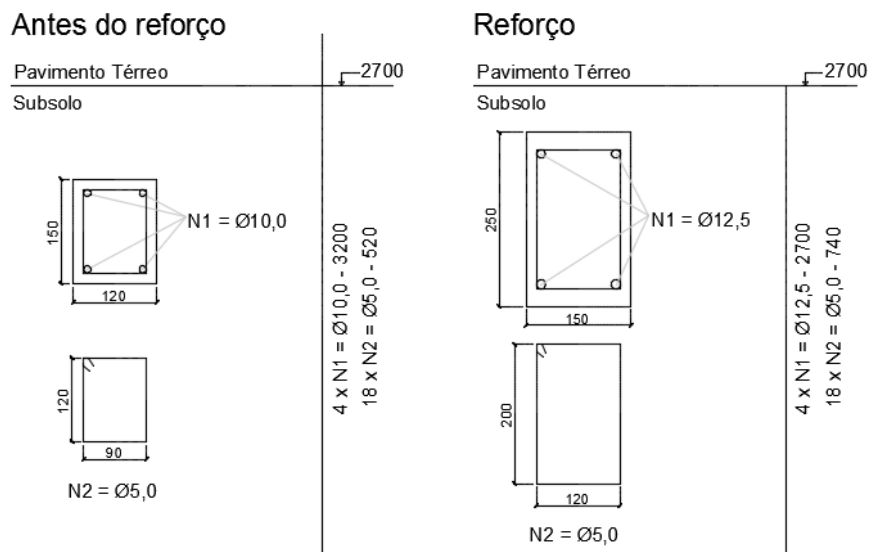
Armaduras dos pilares a reforçar e do reforço.
